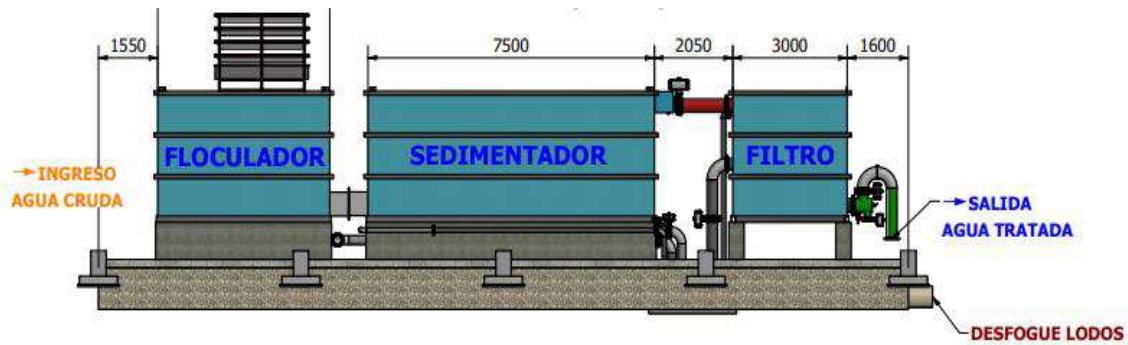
Vista en corte, planta de tratamiento modular 2D
